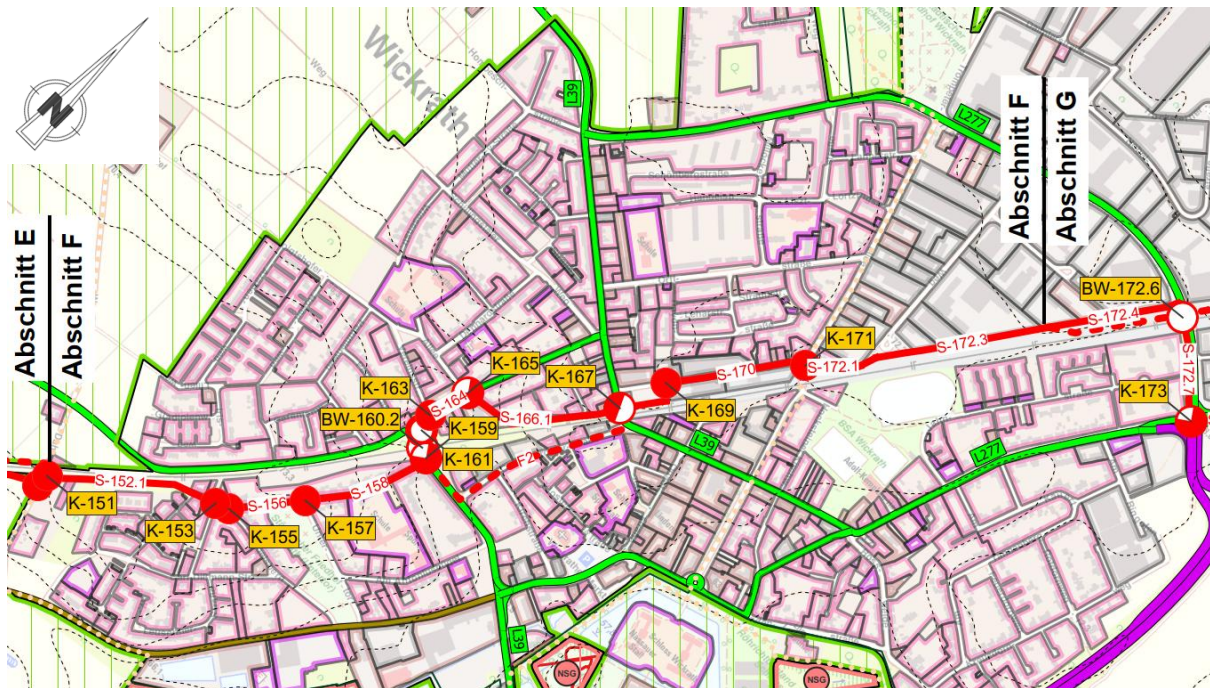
Auszug (Bewertungsabschnitt F) aus dem Übersichtslageplan
